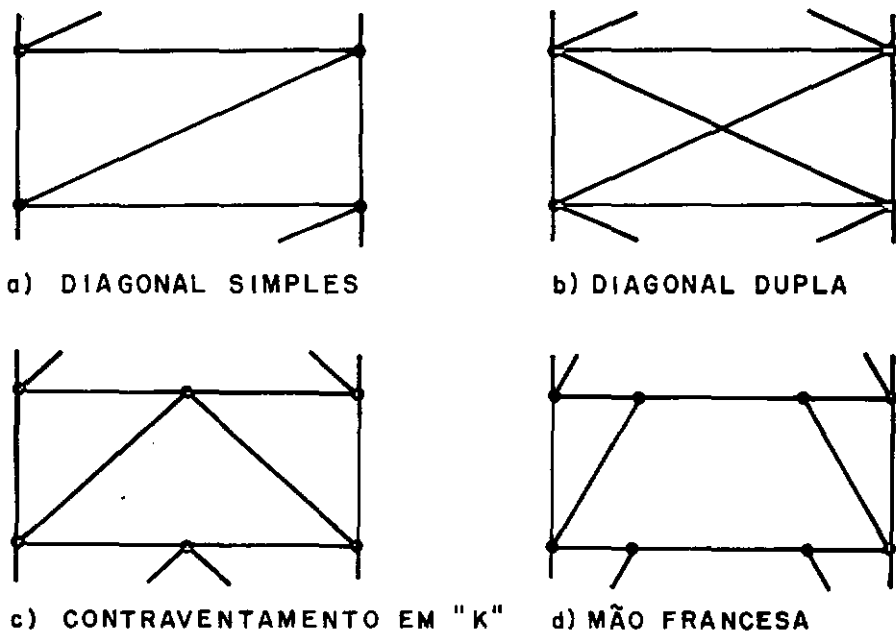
TIPOS DE CONTRAVENTAMENTO
